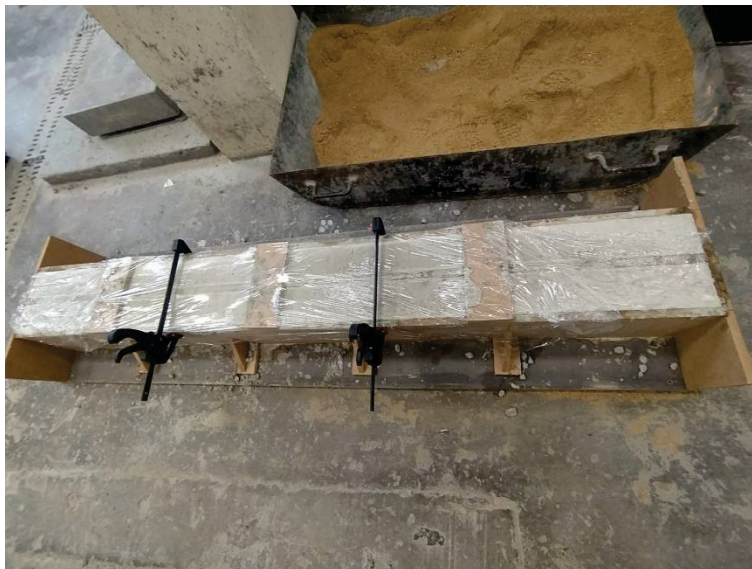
Processo de montagem da caixaria e ferragem da viga
